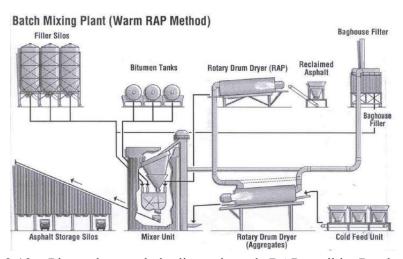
Planta de mezclado discontinua de RAP en tibio. Puede mezclar entre 30% y 80% de RAP. (European Asphalt Pavement Association, 2005)
